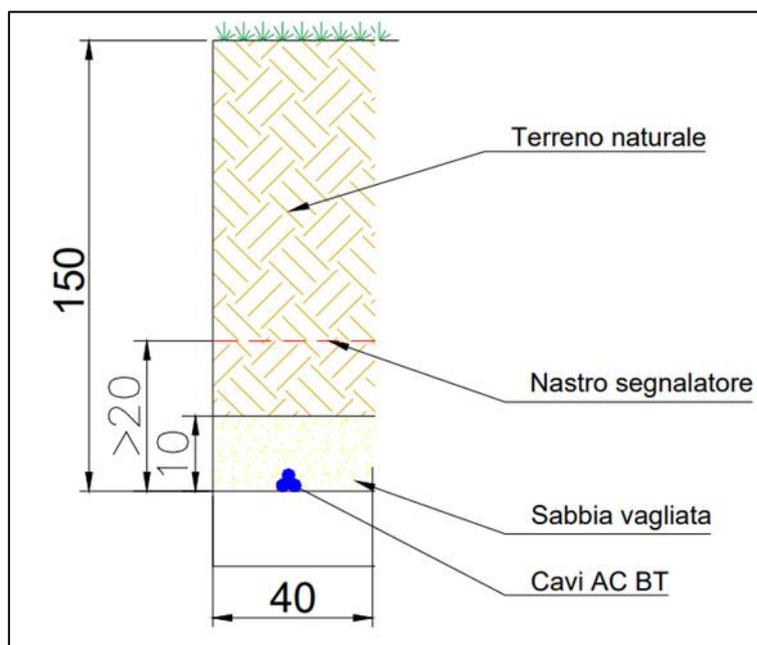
Cavi Bassa Tensione – Sezione 1 cavo singolo
